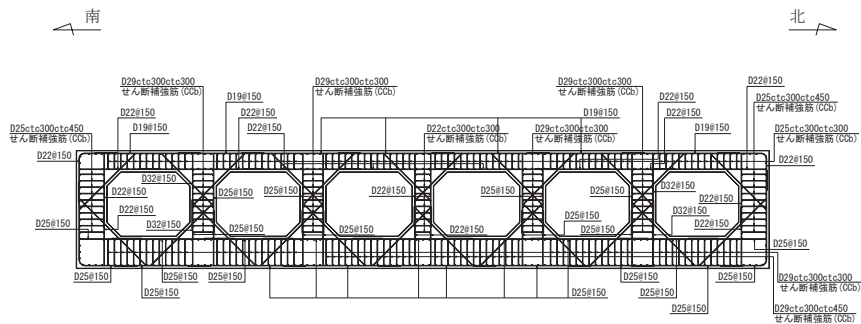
取水口概略配筋図 (B-B 断面, 漸縮部)
